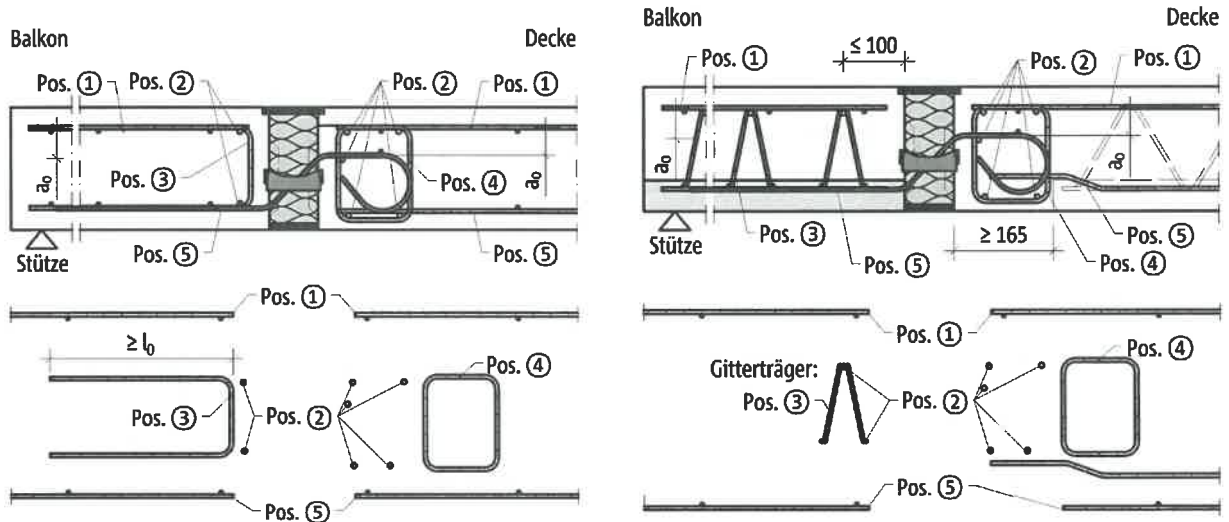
Schöck Isokorb® T Typ Q-V1 bis -V5 6.0, indirekte Lagerung: Bauseitige Bewehrung bei Ortbetonbauweise (links) und Fertigteilbauweise (rechts) schematisch dargestellt
